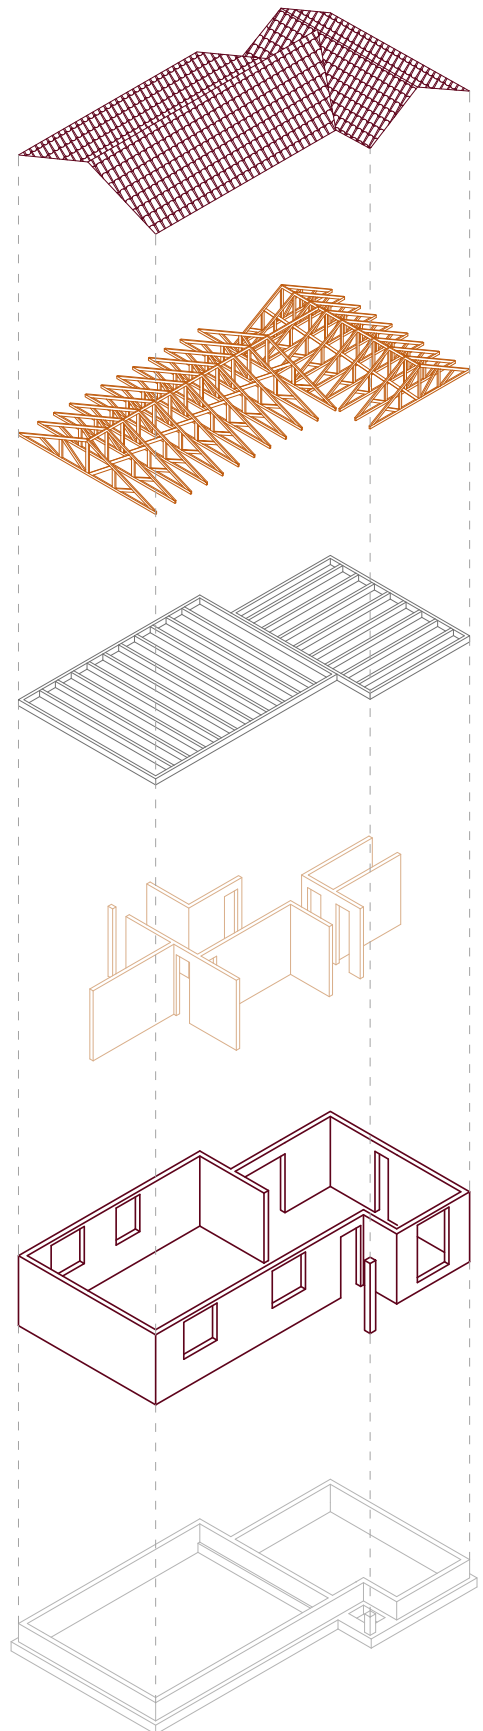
Sistema estructural tipo C2. Fuente: Elaboración propia (2023), en base a trabajo de campo.
